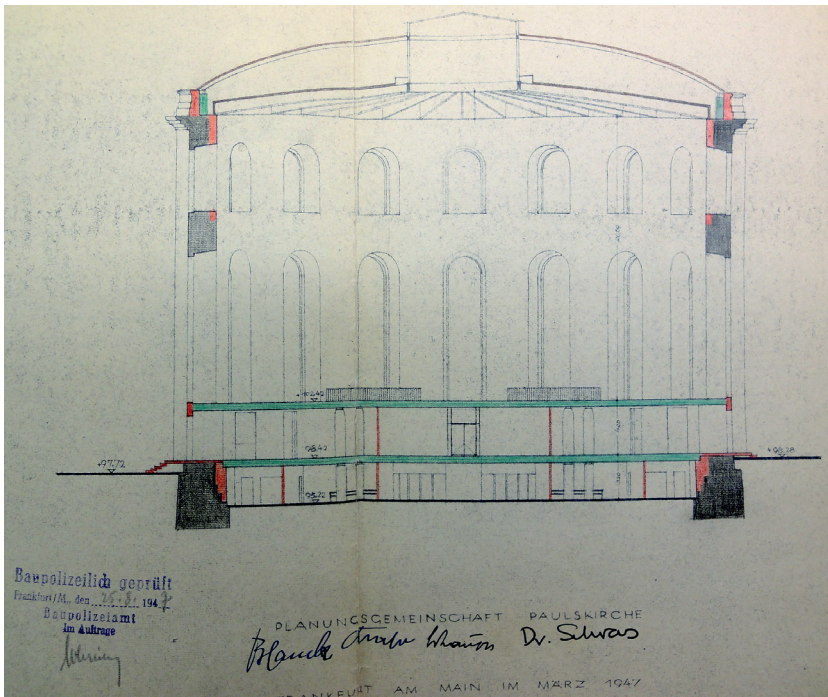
Planungsgemeinschaft Paulskirche, Querschnitt, 1947 Plan: Bauaufsicht Frankfurt, Bauaktenarchiv
